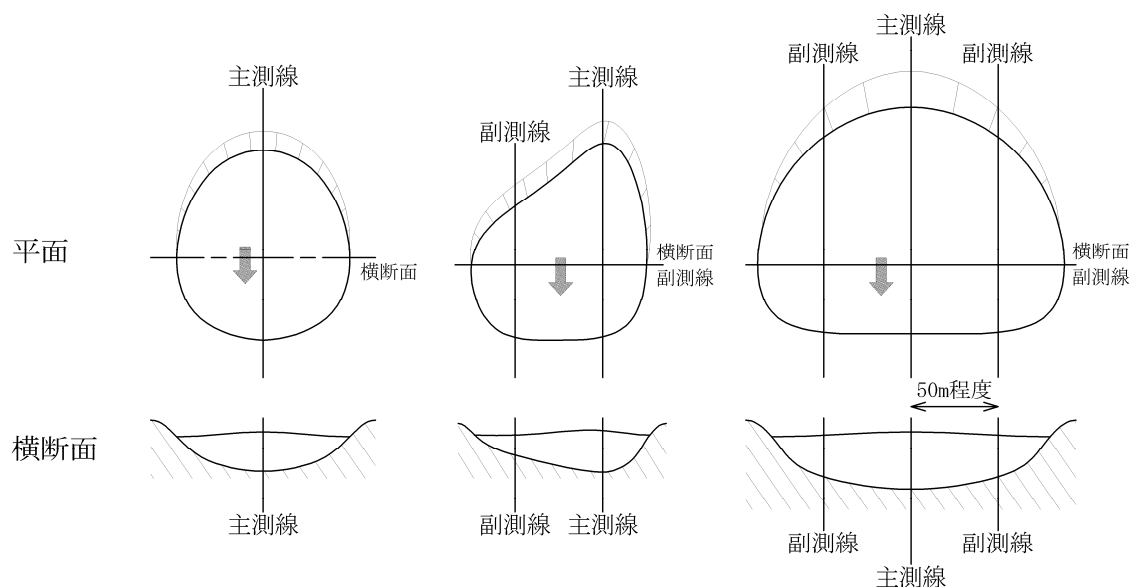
平面・横断面における主測線・副測線の位置¹⁾
